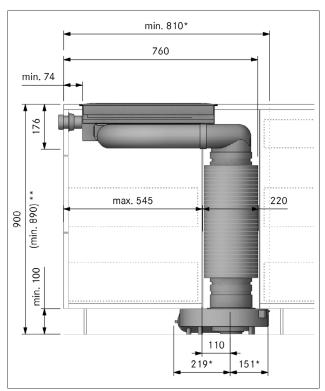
Dimensões de instalação de PKA3/PKA3AB com silenciador redondo para instalação padrão
